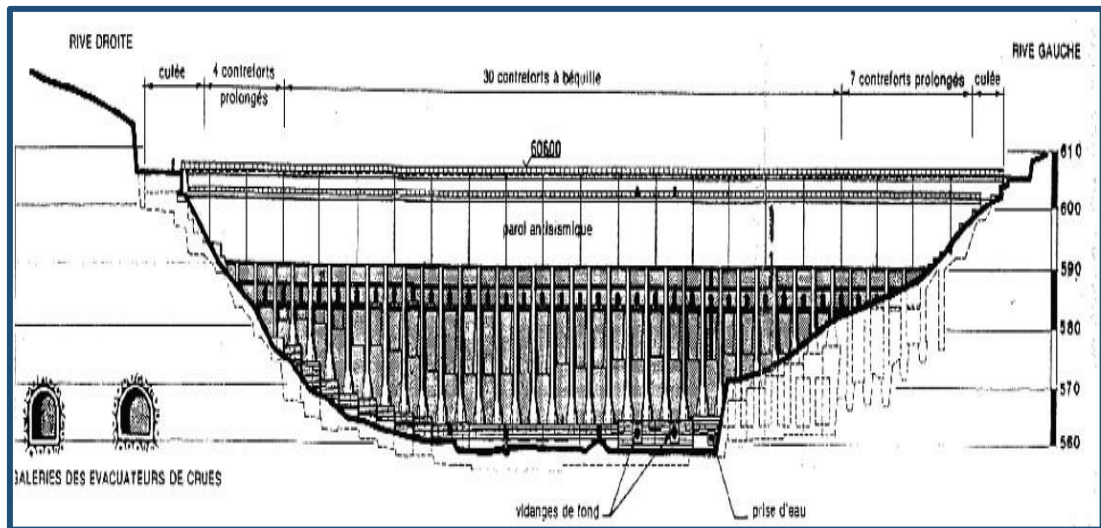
Coupe avale de la digue de barrage K'sob.
